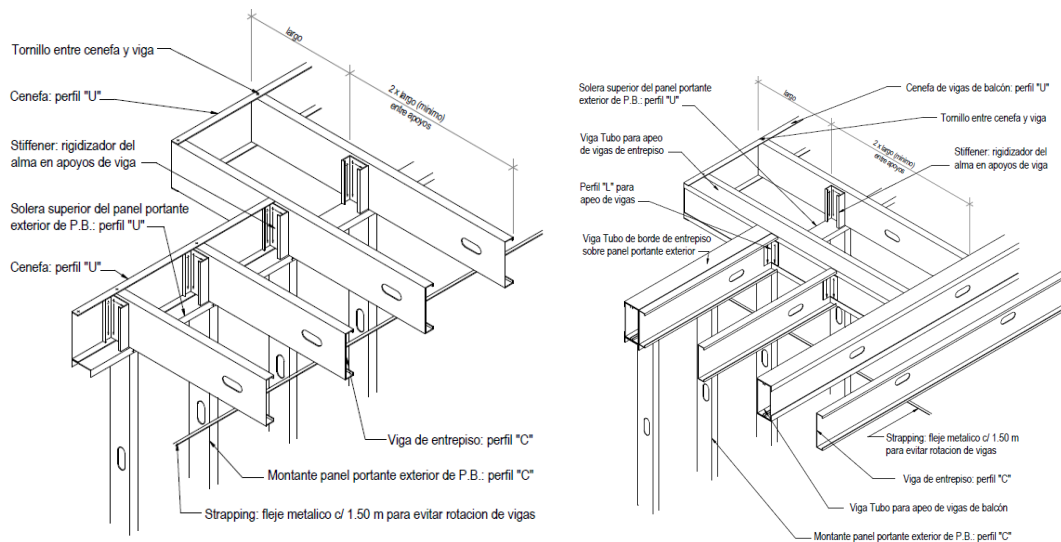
Losa en voladizo. (ConsulSteel, 2002).
